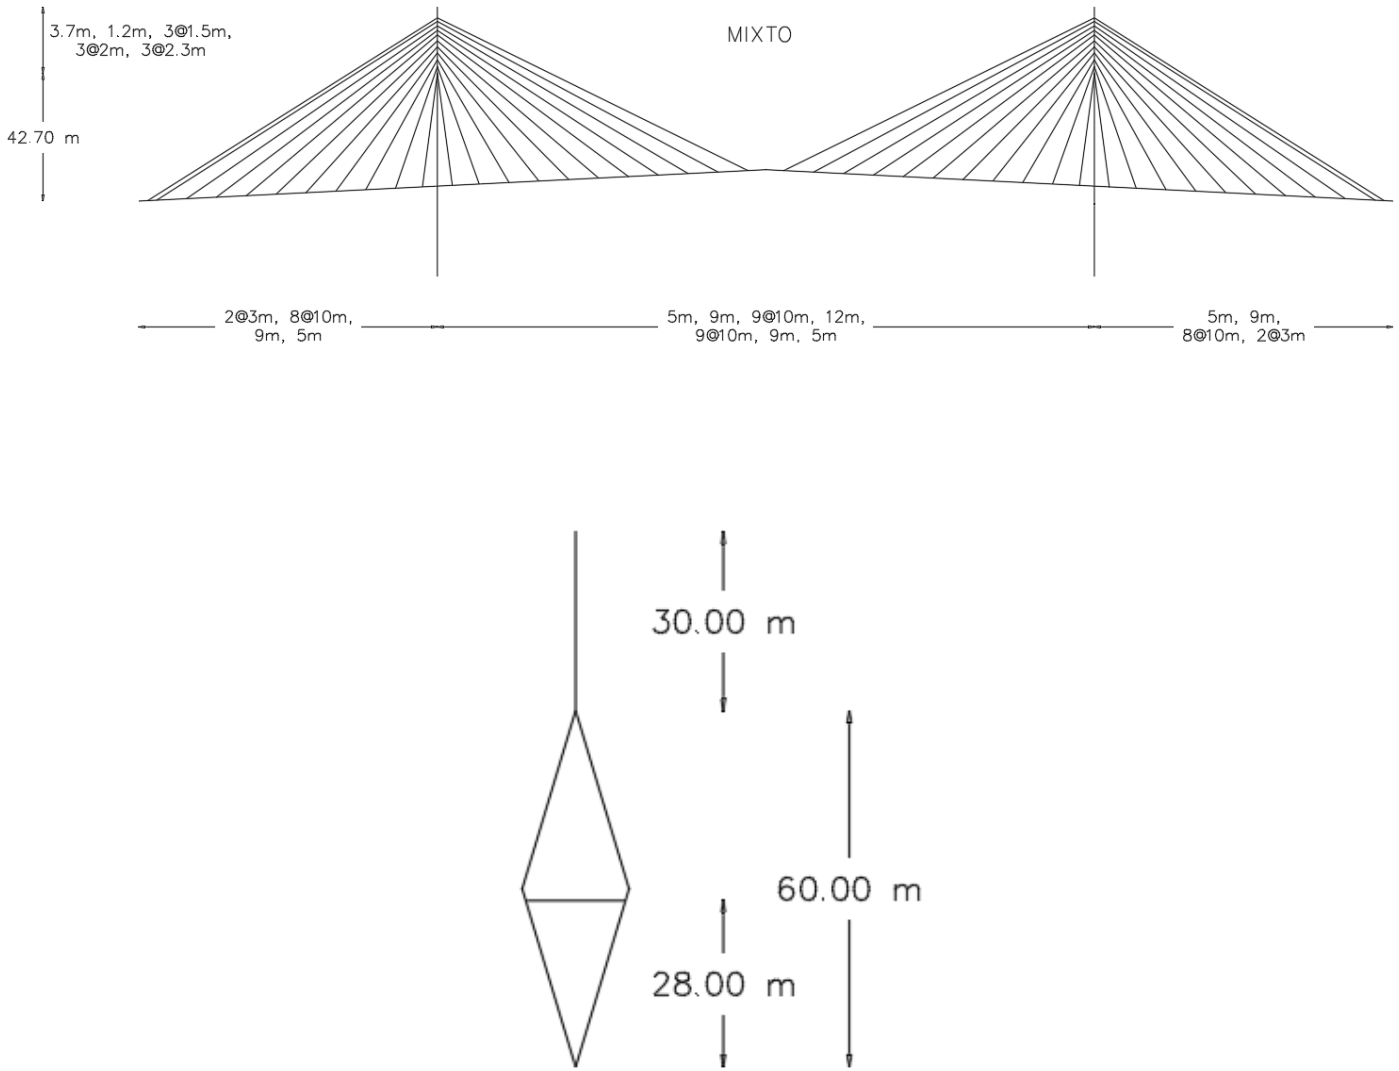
Estructura atirantada un único plano central, tipología mixta
